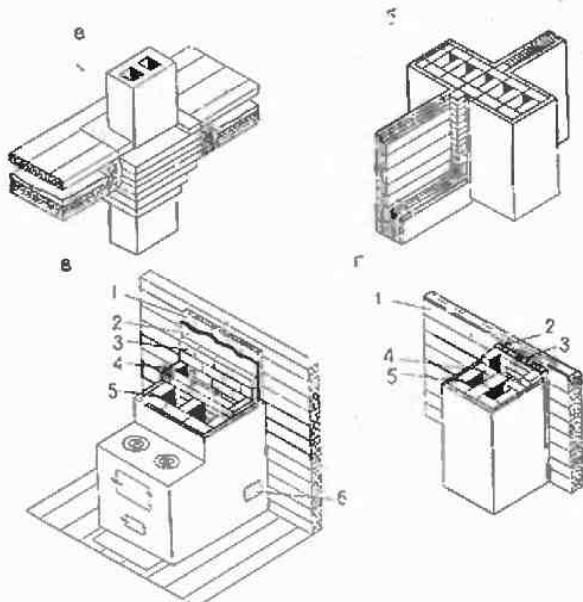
Противопожарные устройства в зданиях с печным отоплением
